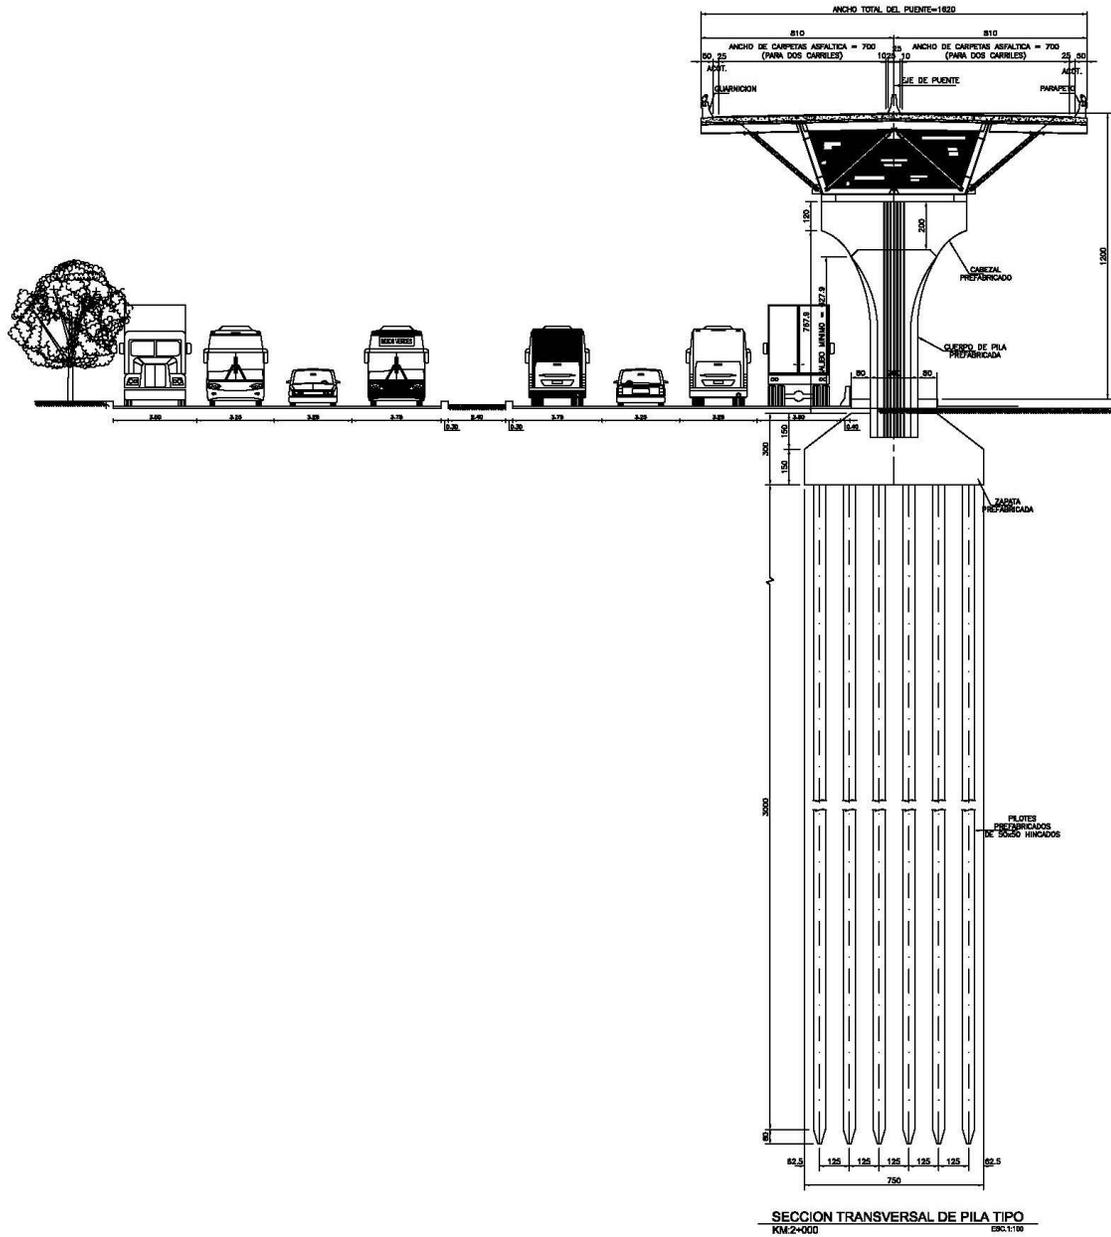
Sección transversal tipo para tramos de dos carriles por sentido A4 cimentados con pilotes.
